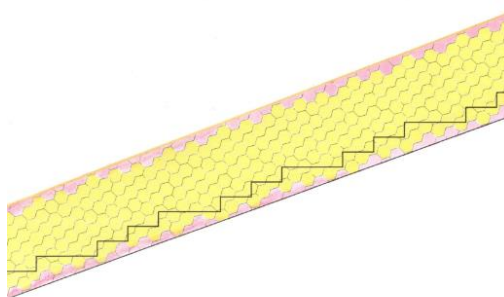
Alçado esquemático das peças cerâmicas e degraus da bancada da cobertura.
